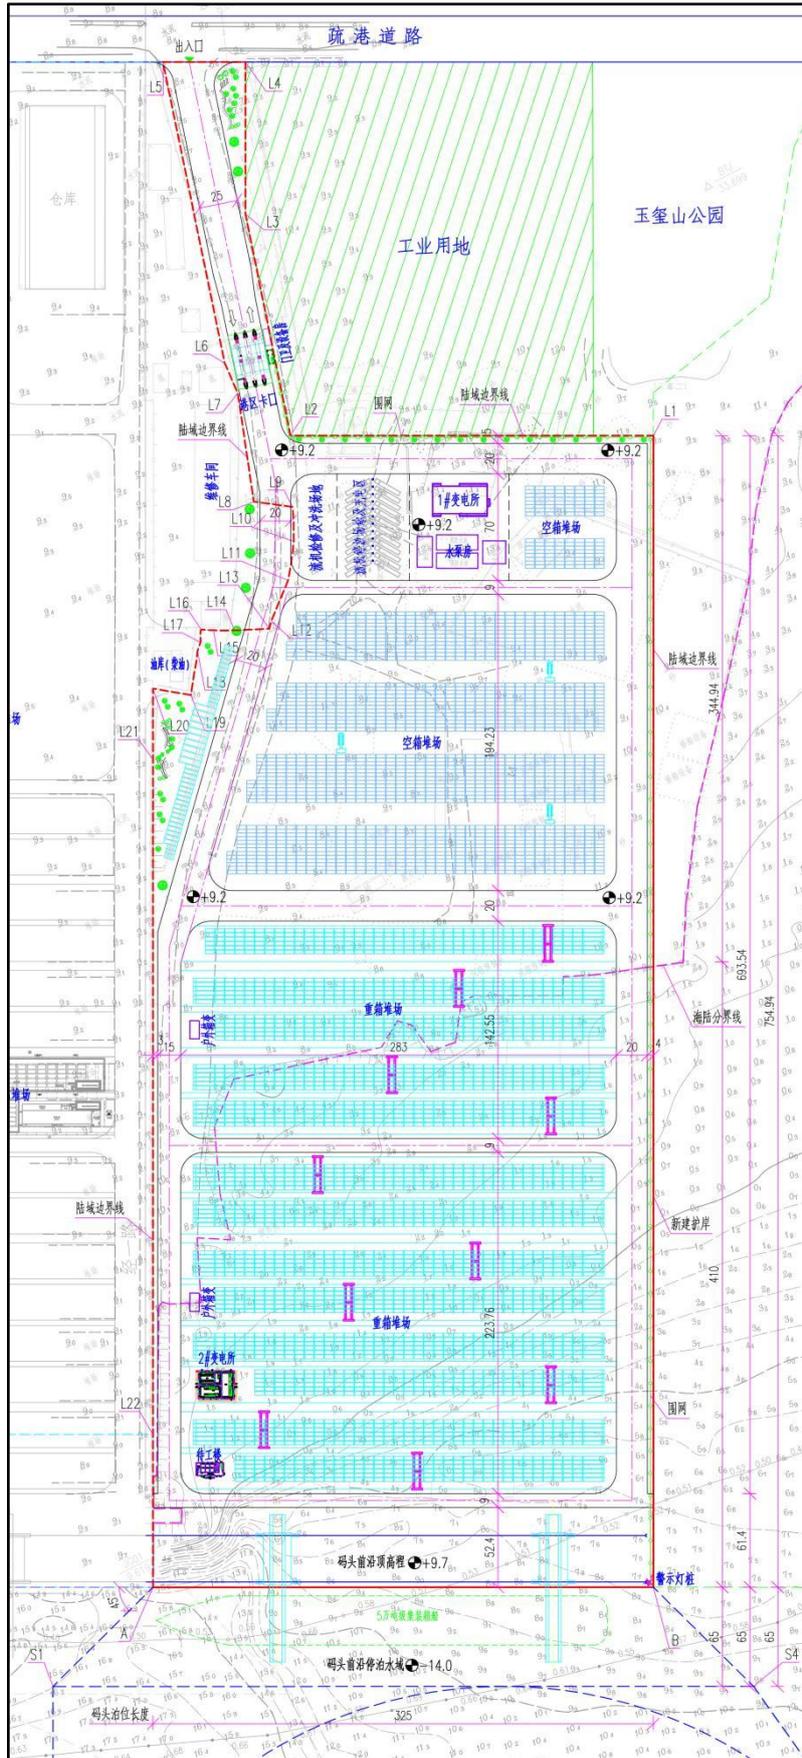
重力式沉箱+后方陆域回填方案平面布置图
